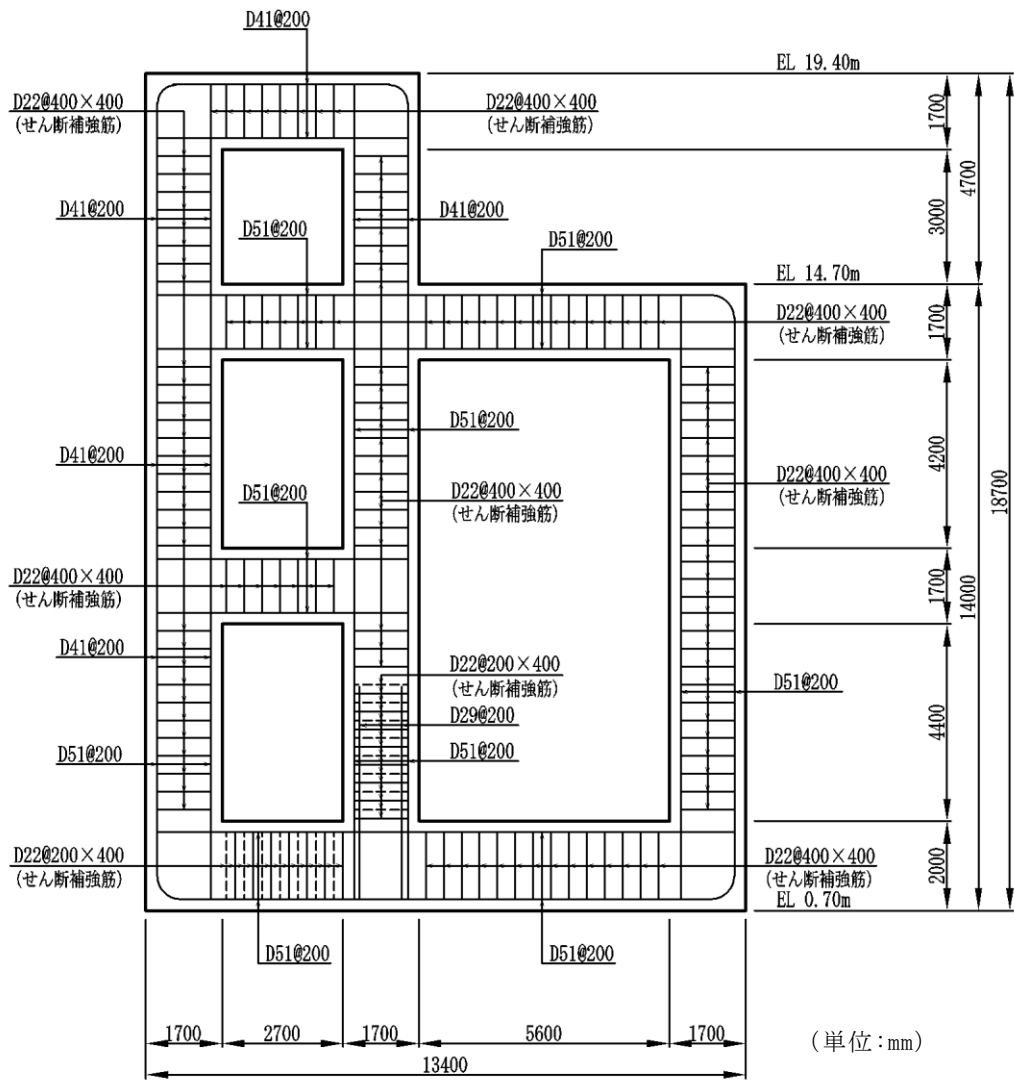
第 1 ベントフィルタ格納槽概略配筋図 (A-A 断面)
